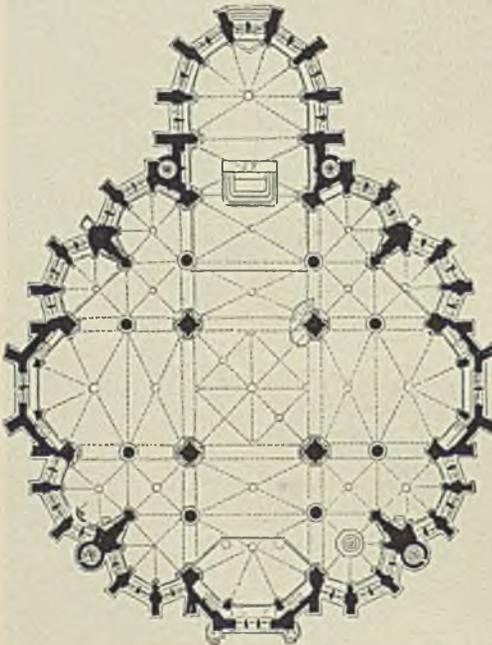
Grundriß der Liebfrauenkirche zu Trier
